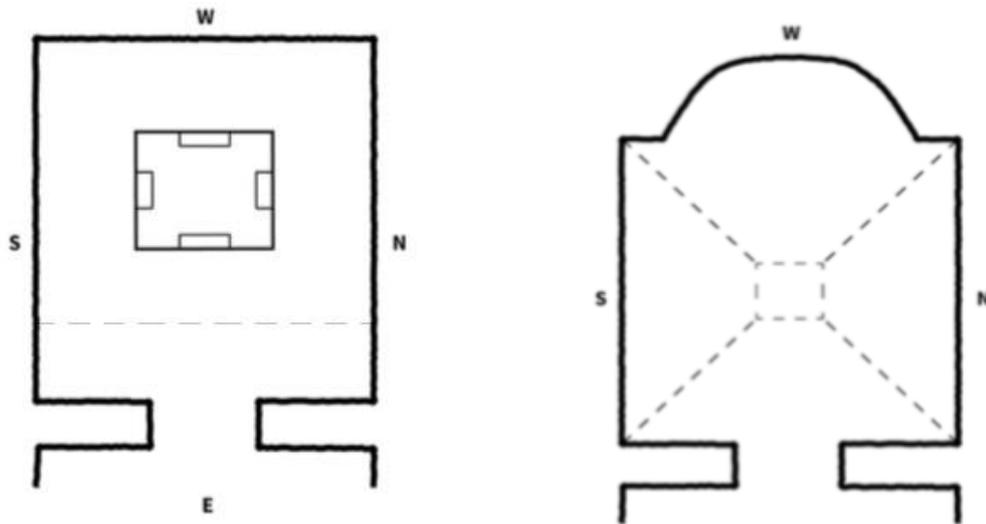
Planimetria grotta con Stūpa, planimetria grotta sala templare. | Riferimenti immagine: Wang C. Michelle (2018) "Dunhuang Art" di Ernest Baroni.
